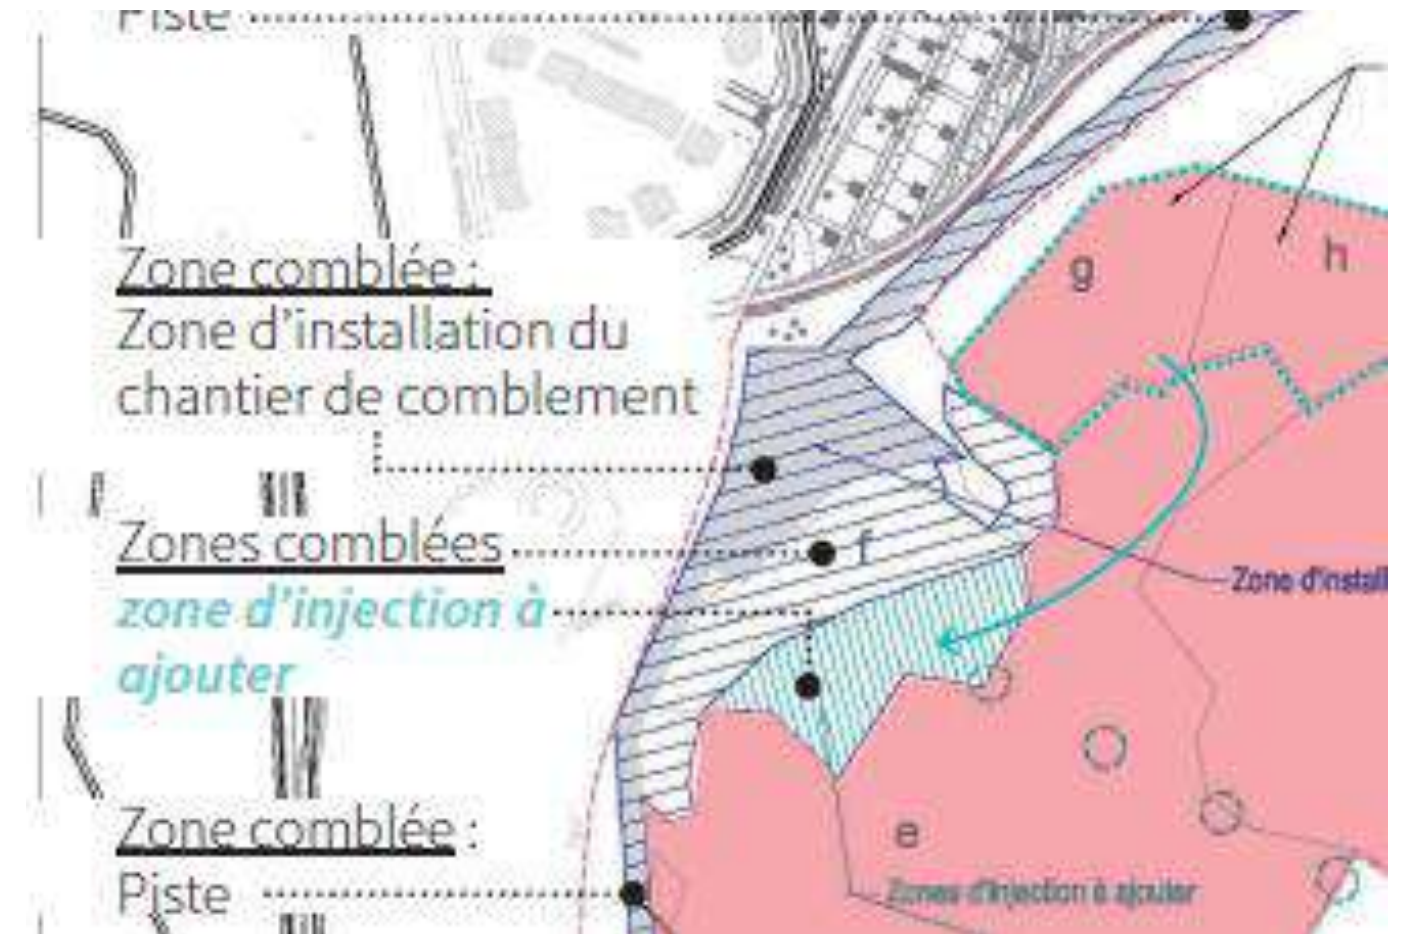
localisation installation de chantier pour les travaux d'injection - source: EGIS
